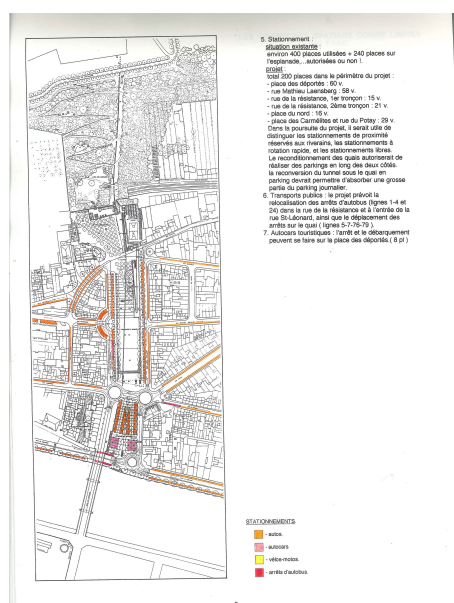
point 5 : plan et répartition des stationnements, plan réalisé par le bureau Béguin Massart, 1996
